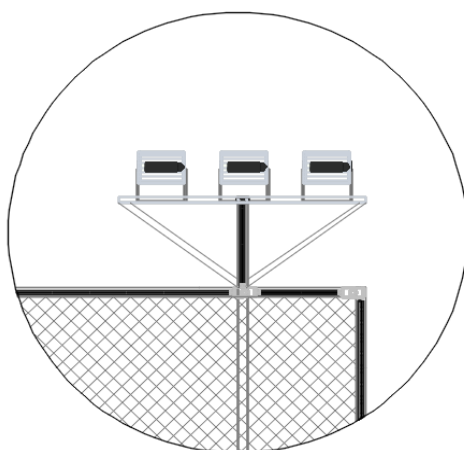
Detalhe de instalação dos refletores (Fonte: Autor/2025)
